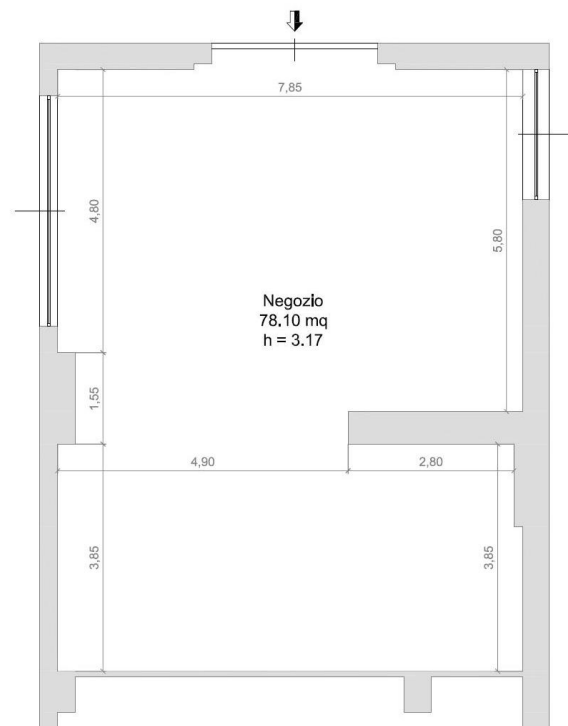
Planimetria Stato di fatto Foglio 46, p.lla 1235, sub 12.
